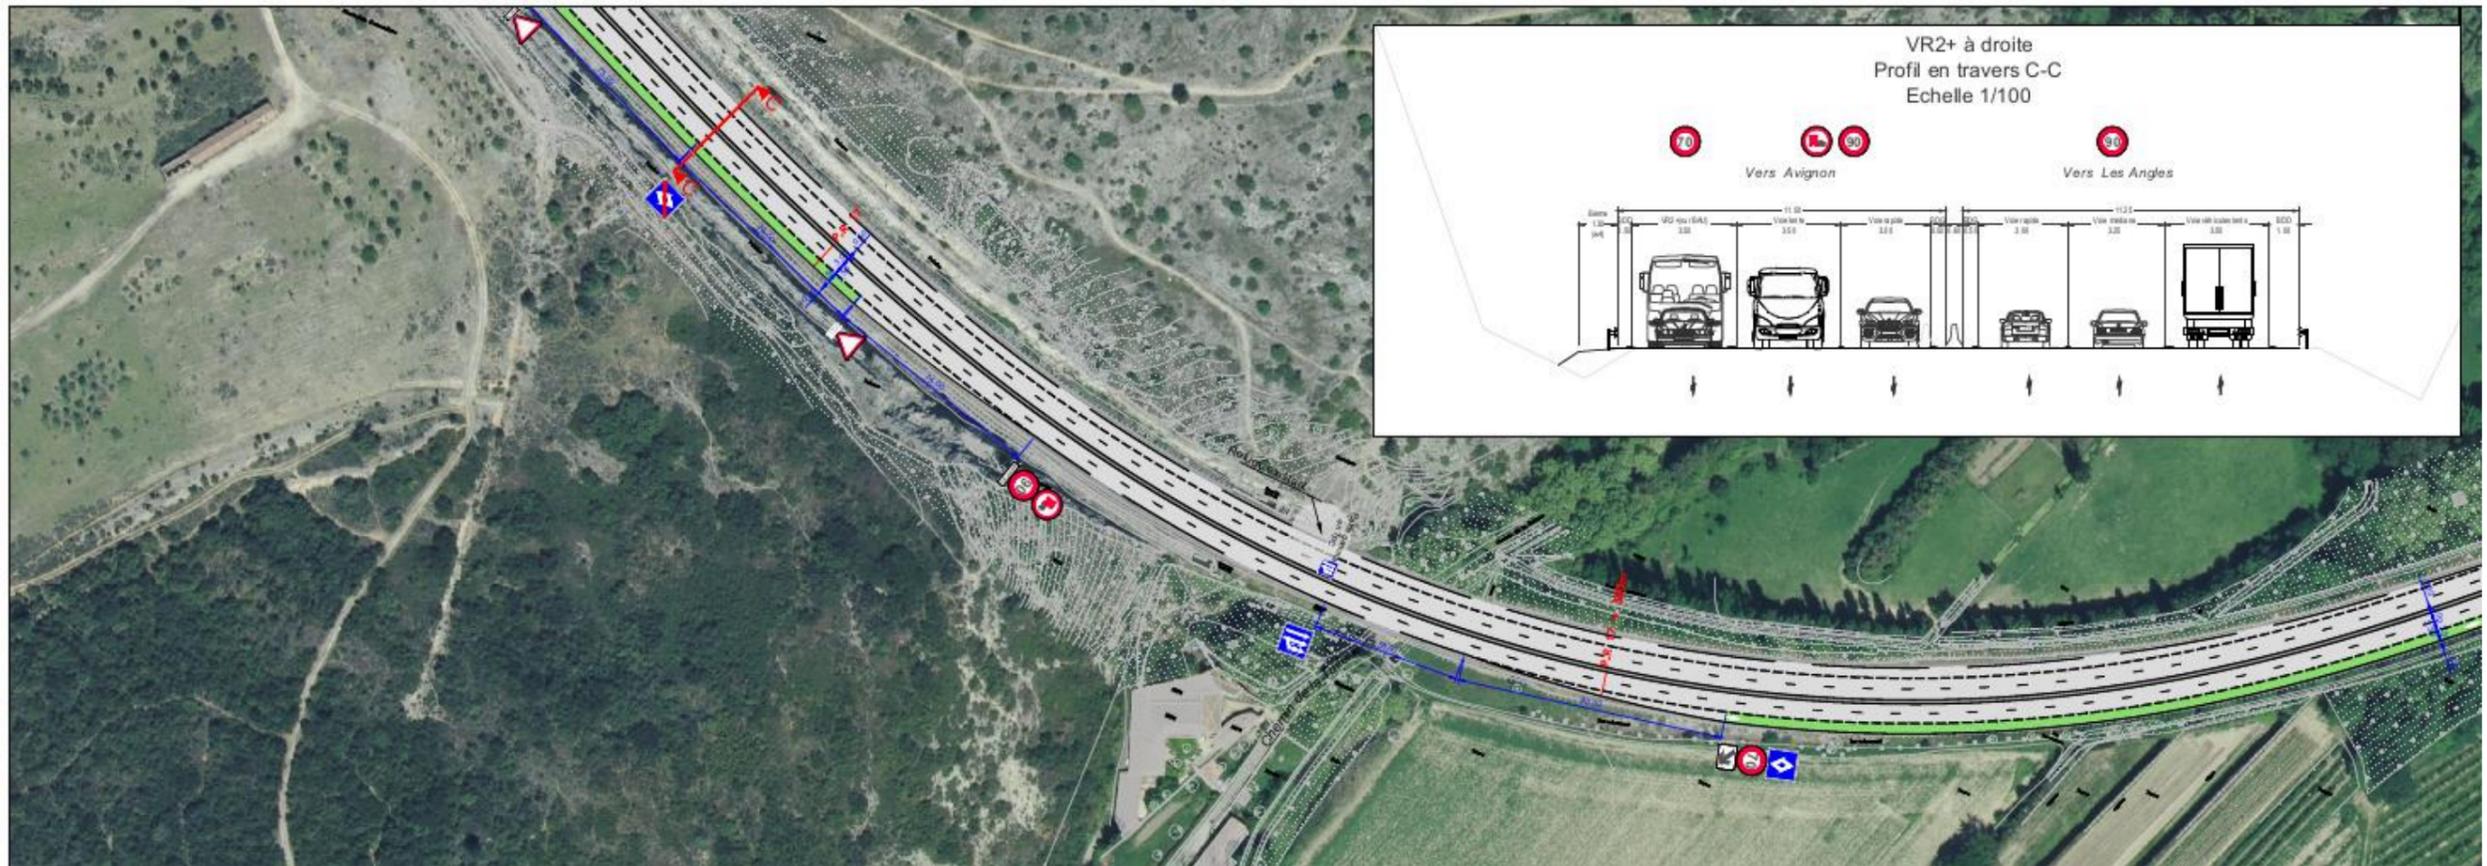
PLAN MASSE VOIE RESERVEE SECTION COURANTE, ETUDE PRELIMINAIRE, EGIS
